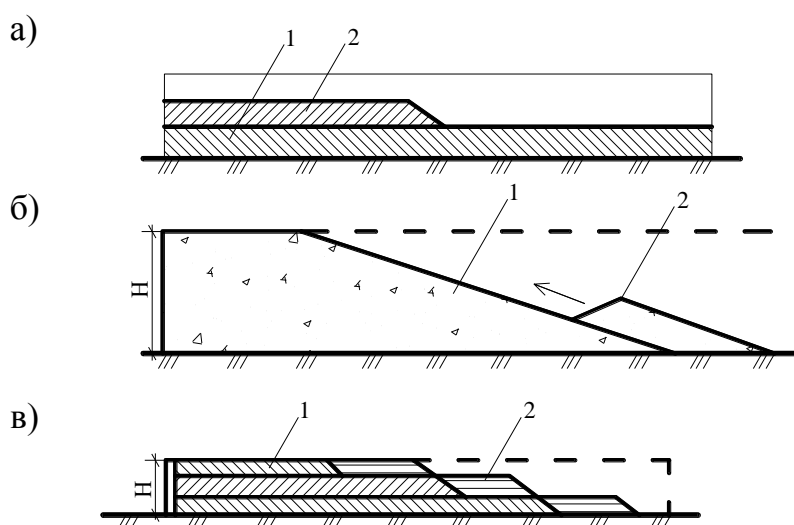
Способи укладання бетонної суміші: а – горизонтальними шарами; б – похилими шарами; в – ступенями; 1 – укладений бетон; 2 – новий шар бетону
